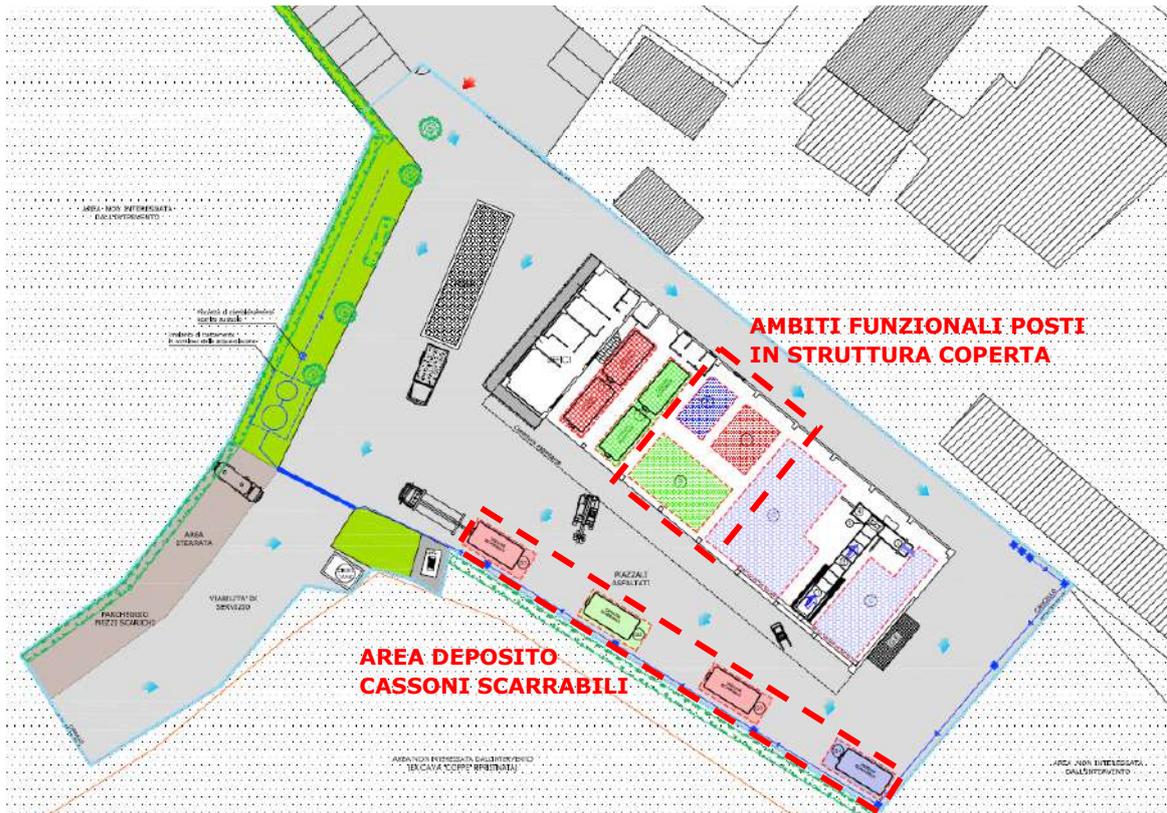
Individuazione delle modifiche planimetriche del layout autorizzato
